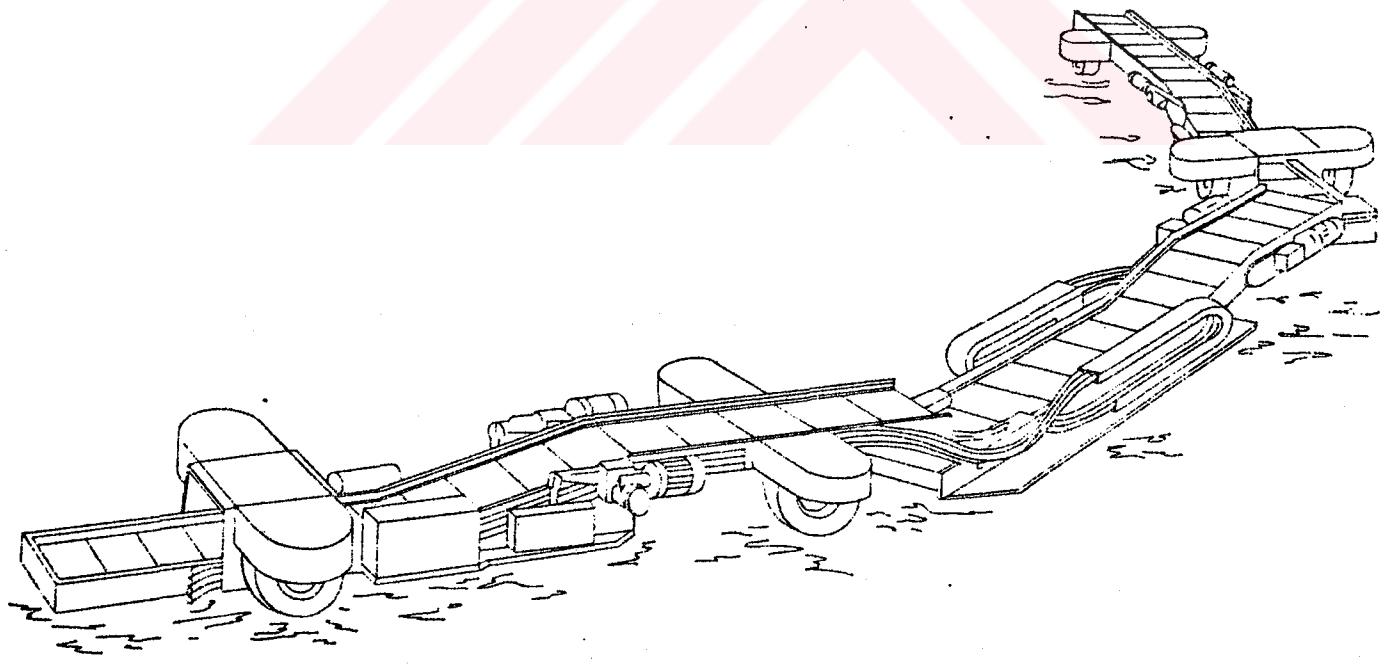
Ramcar plan ve kesit görünüşü (Walker, 1992).
